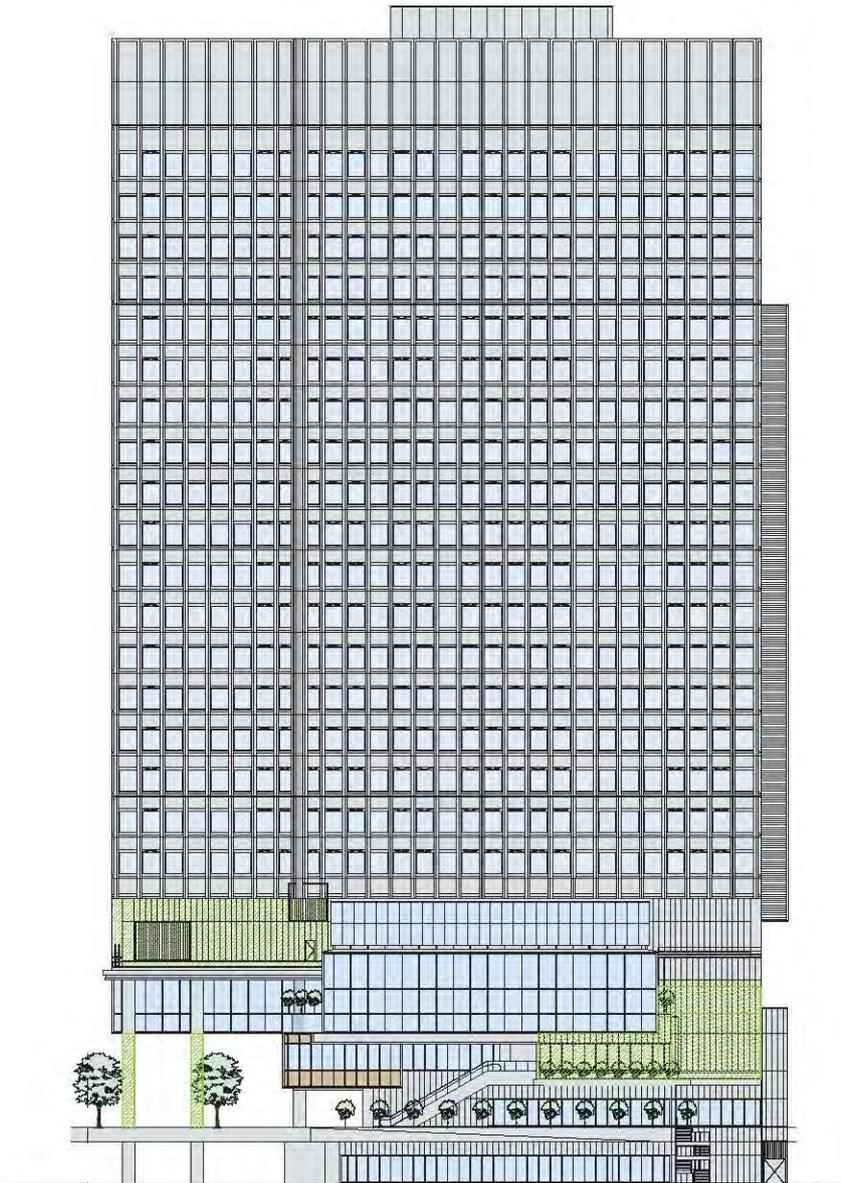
(3) 立面图 (南立面图 S=1:800)
